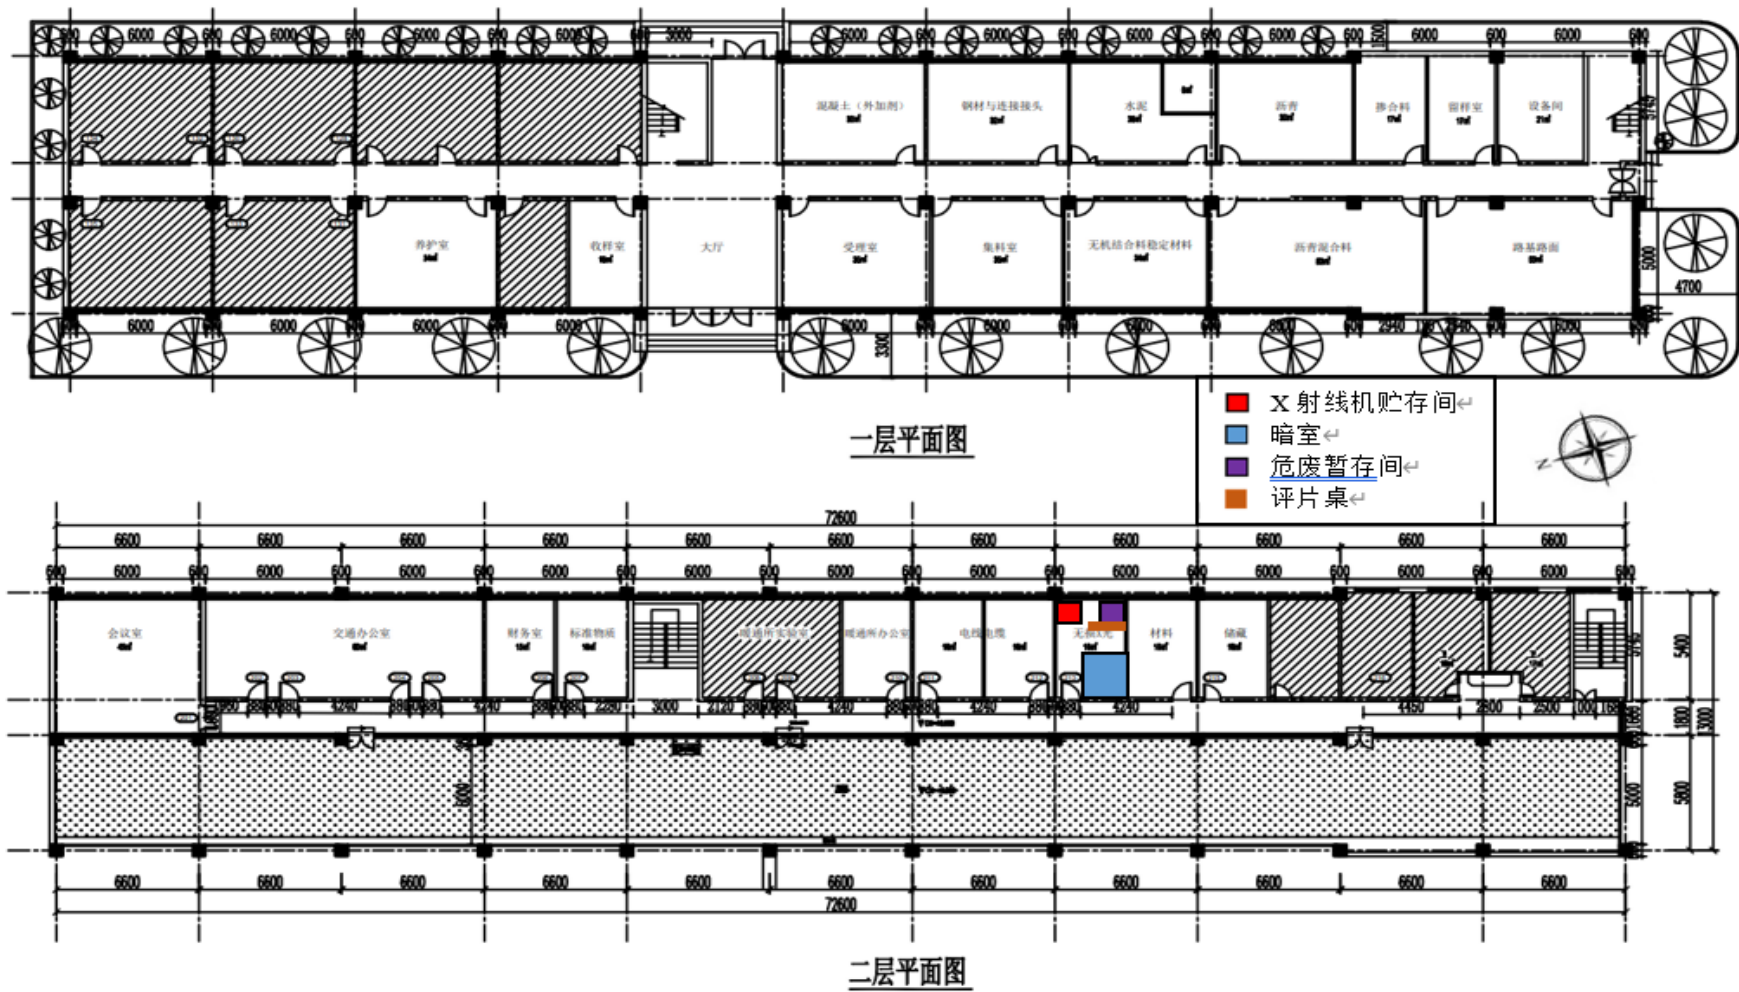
浙江省建设工程质量检验站有限公司实验楼总平面布置示意图
